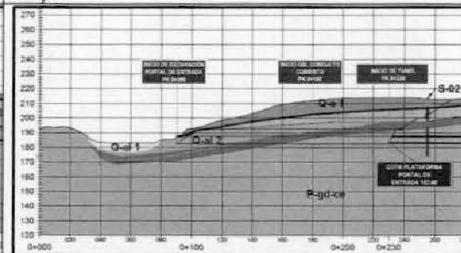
Planta Geológica del Entregable 1.
